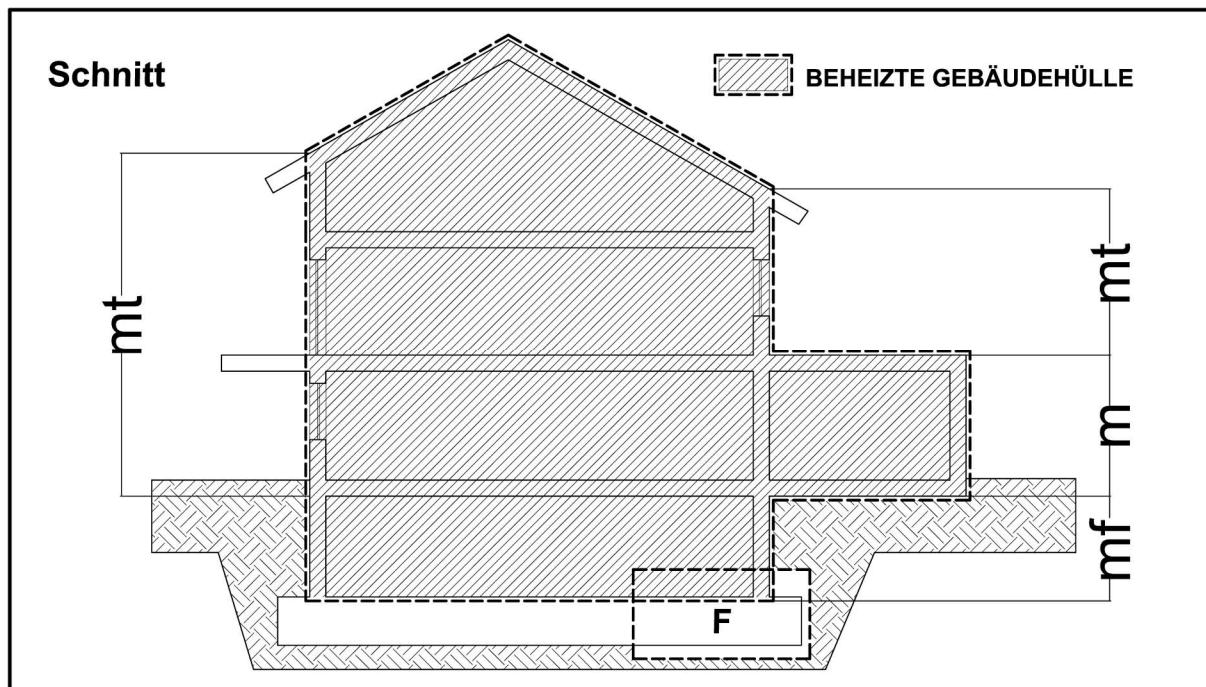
anzusetzende Bruttogeschoßhöhe/-gebäudehöhe der wärmeübertragenden Umfassungsflächen.
